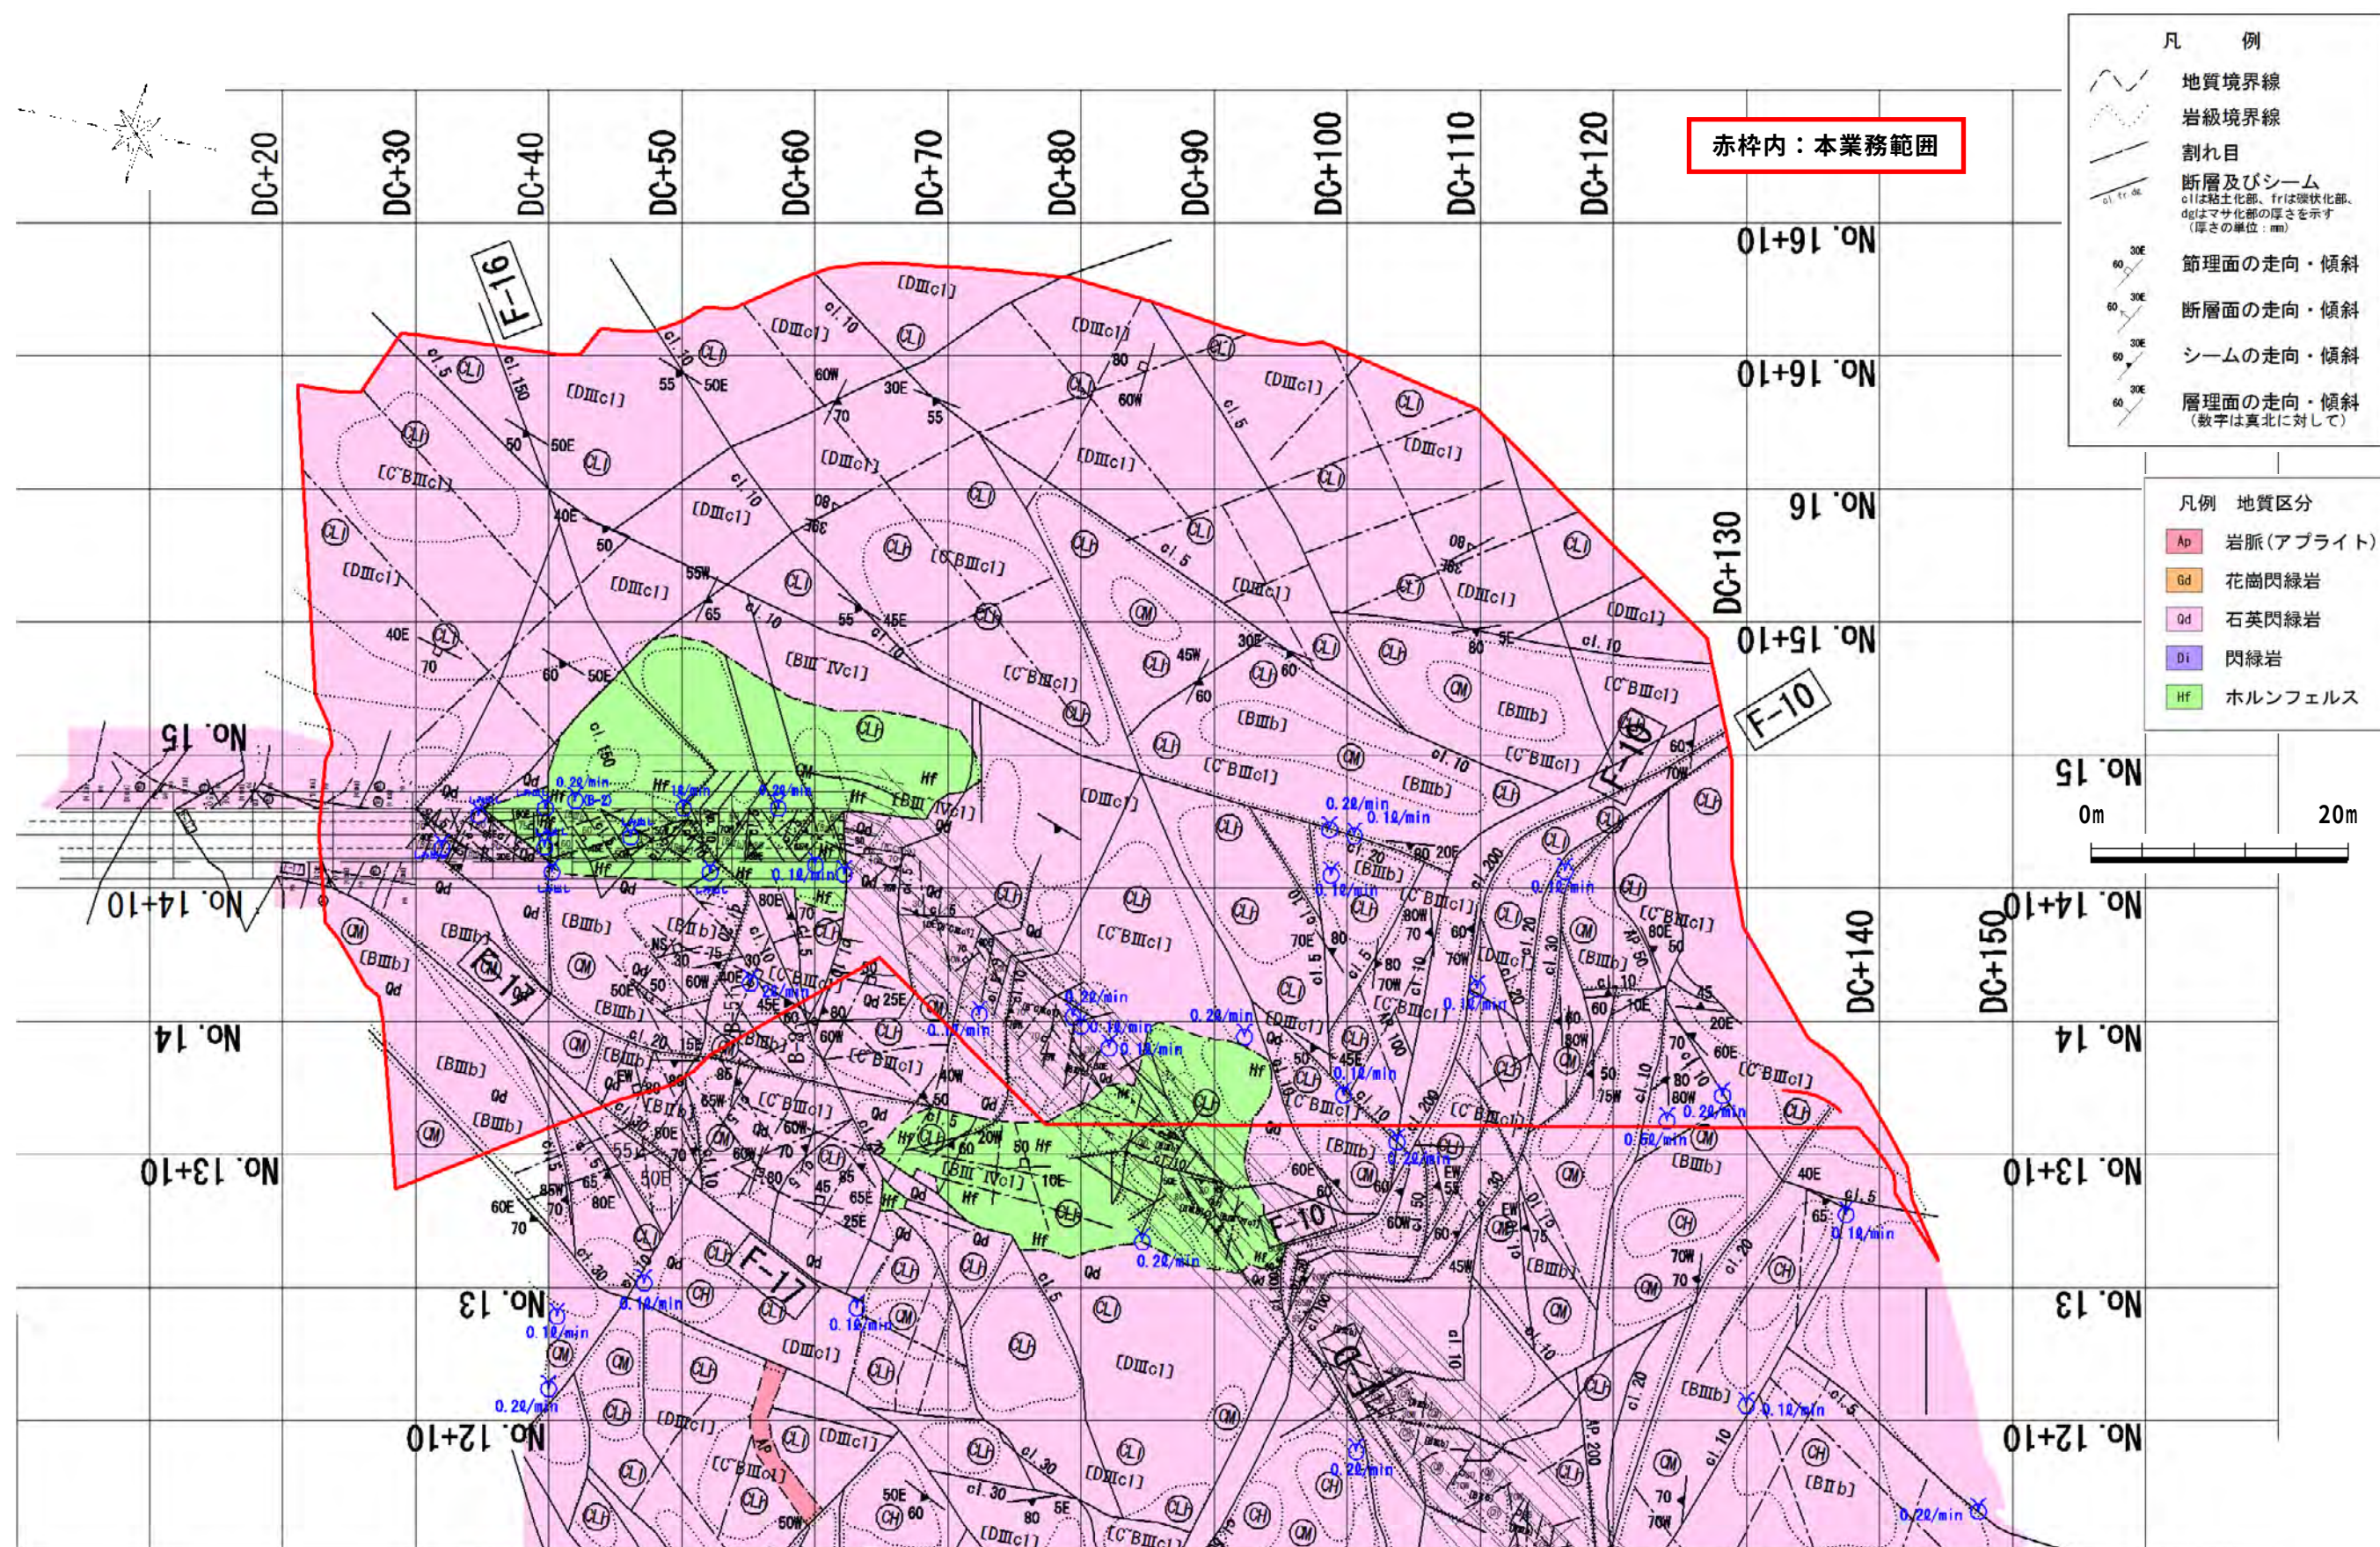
岩盤スケッチ平面図(地質区分)(下流側)
